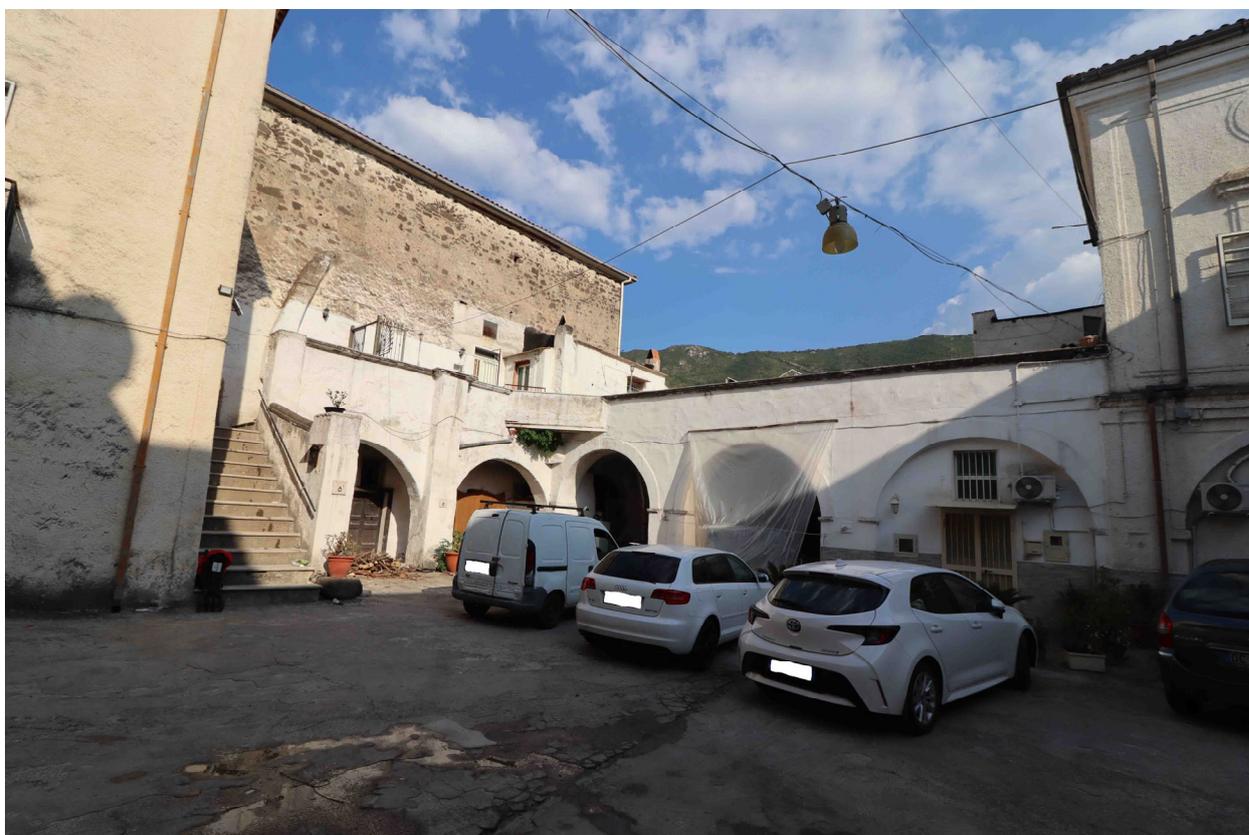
04 – L'unità immobiliare residenziale staggita Sub 19 al piano I°-II°
